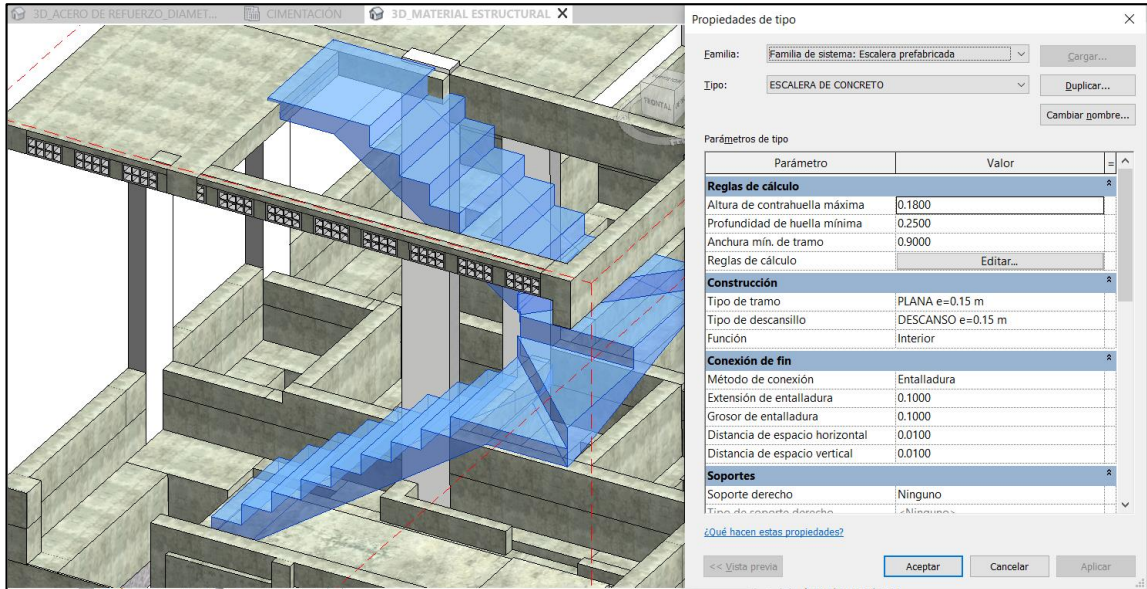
Vista 3D – Escalera en Caja de Sección en BIM
